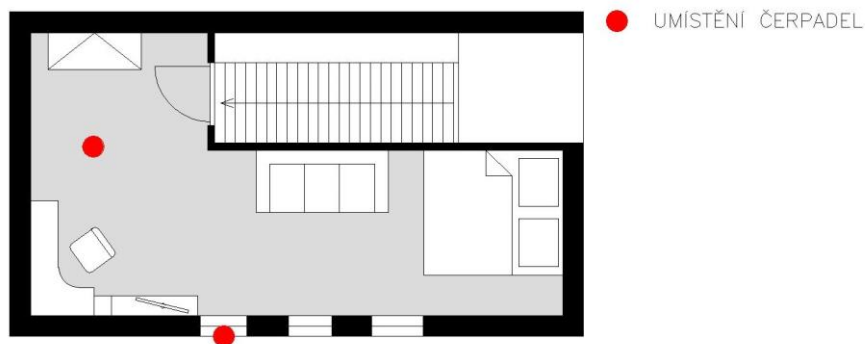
Ochoz u Nasavrk: půdorys přízemí (vlastní zpracování)
